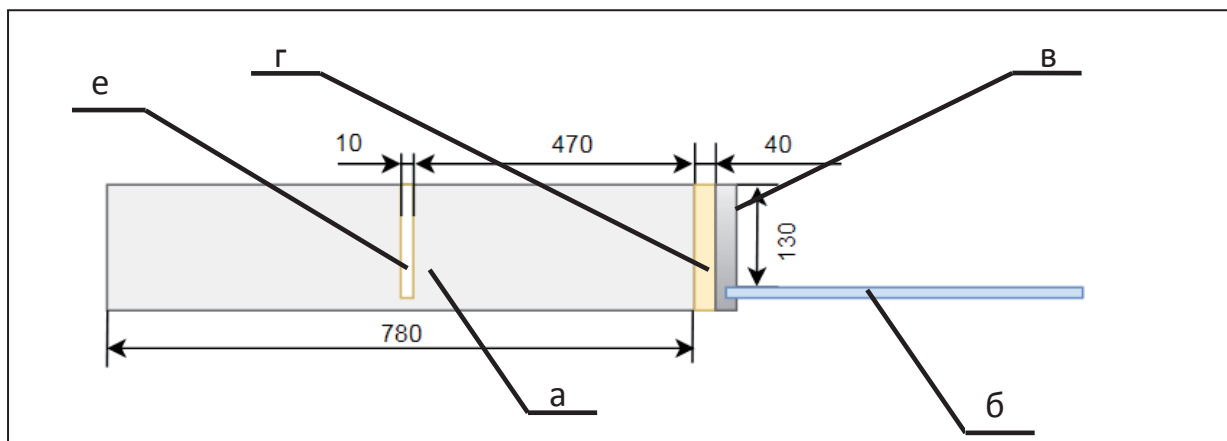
Схема узла исследуемого фрагмента. Дефект кладки прямоугольной формы, толщиной 10 мм, высота 140 мм, глубина 190 мм., без утепления наружной поверхности стены: а – стена; б – стеклопакет; в - оконный профиль; г - пенный шов; д – утеплитель.
